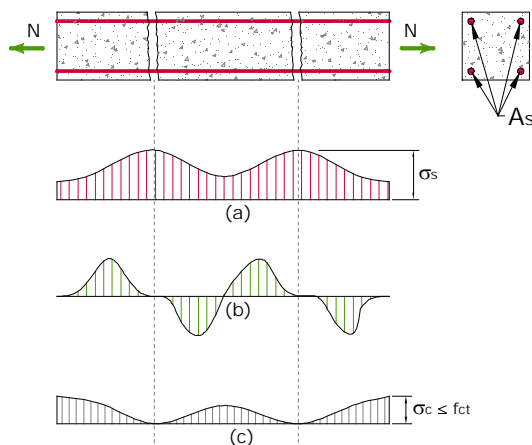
Tensões em um elemento fissurado submetido a esforço axial; (a) tensão na armadura; (b) tensão na interface entre concreto e o aço; (c) tensão no concreto. Adaptado de Ghali & Favre (1993).
